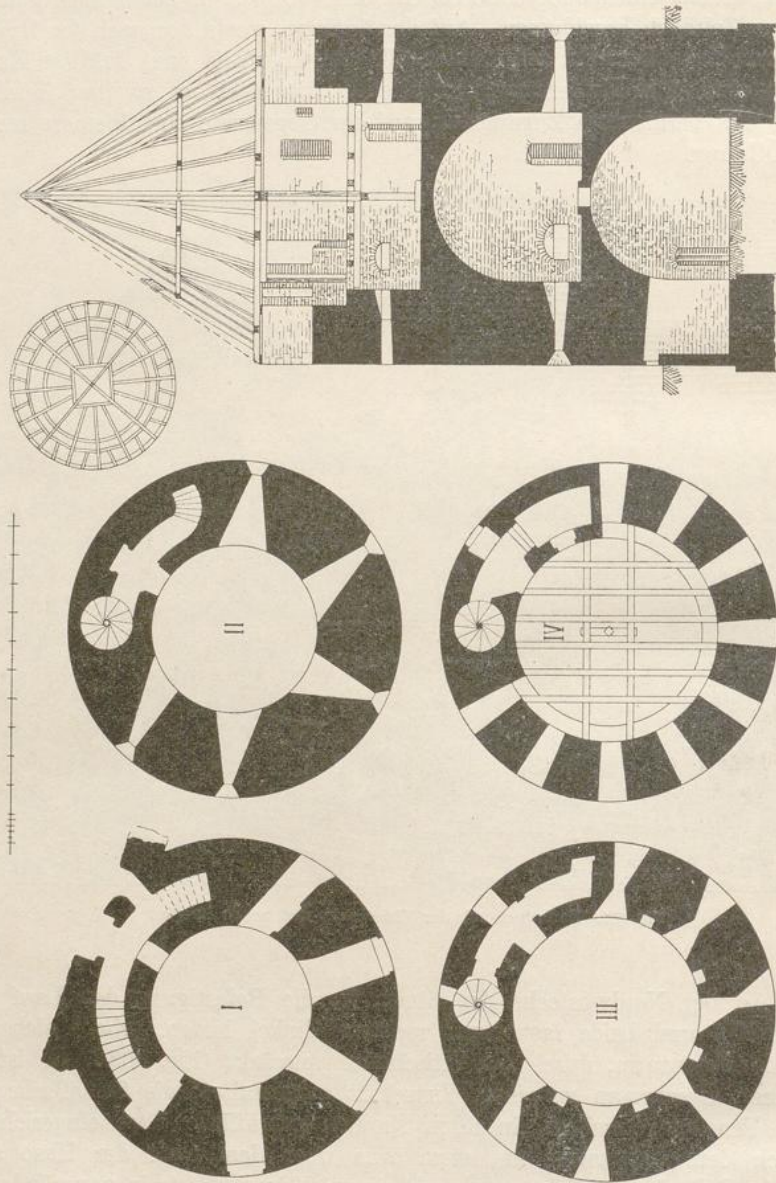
Der Bürgergehorst; Grundrisse und Schnitt.
